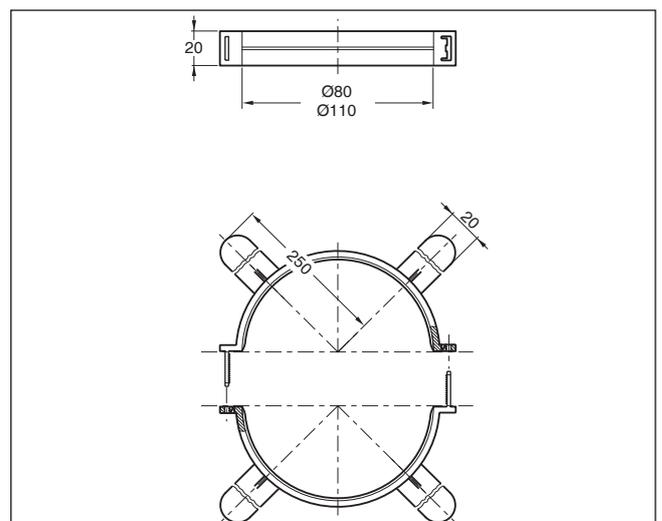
Abstandshalter für Abgasleitung im Schacht (Maße in mm)
